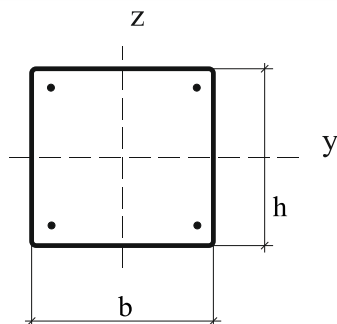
Поперечное сечение трубобетонной колонны эстакады
